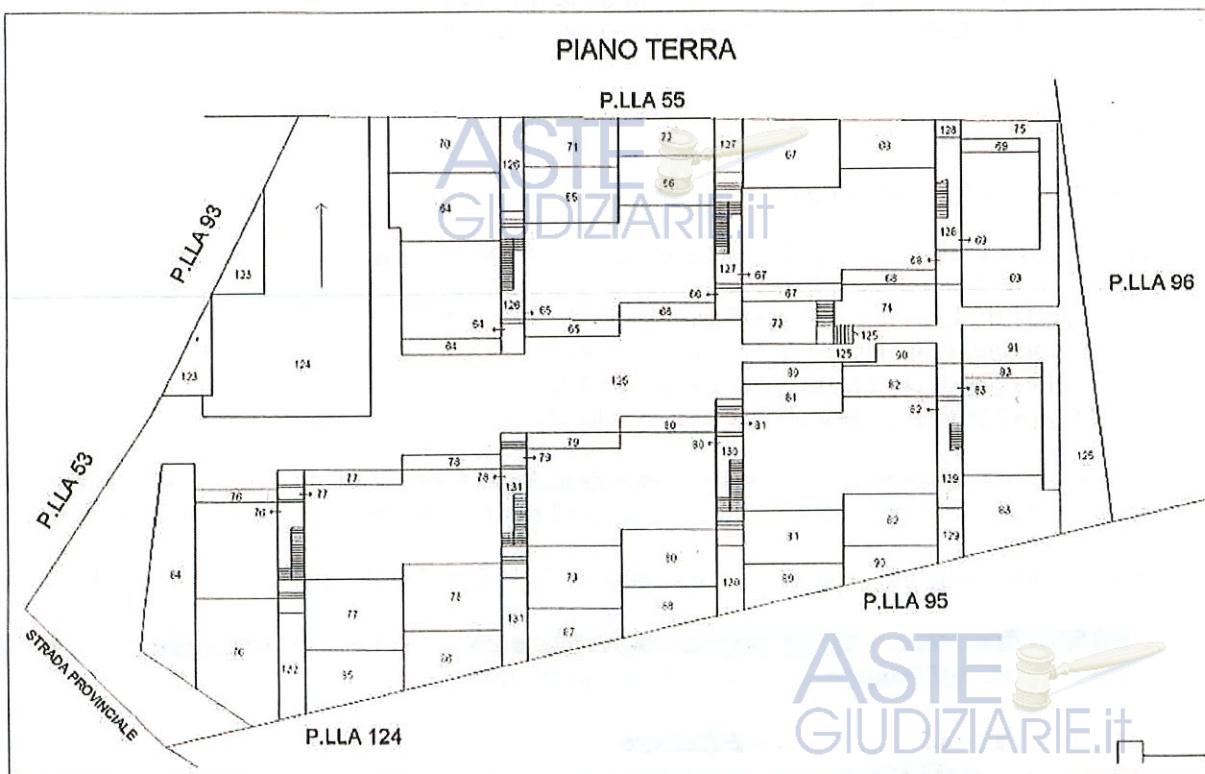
Estratto elaborato planimetrico catastale - piano terra
